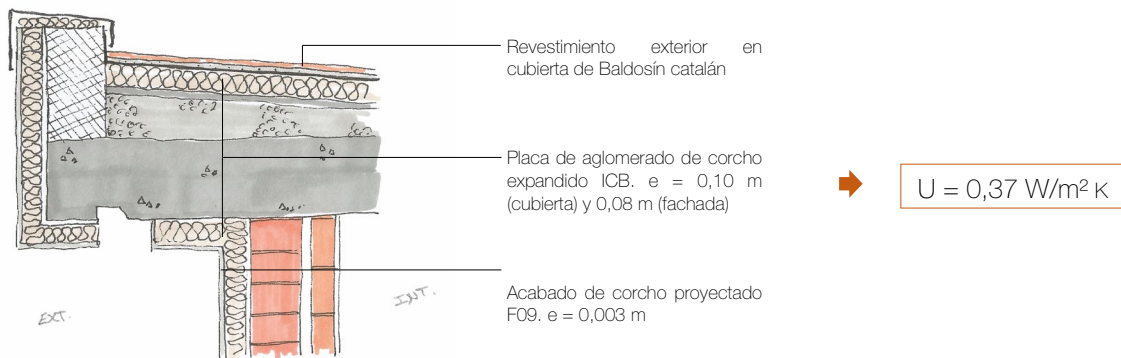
Detalle encuentro de fachada aislada con sistema SATE y cubierta plana convencional aislada (autoría propia).
